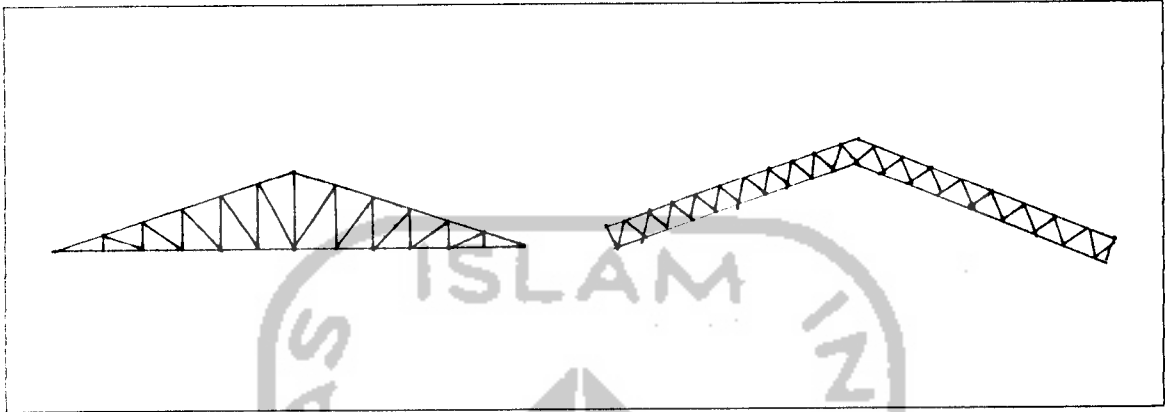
Rencana sistem struktur bangunan dan tapak
